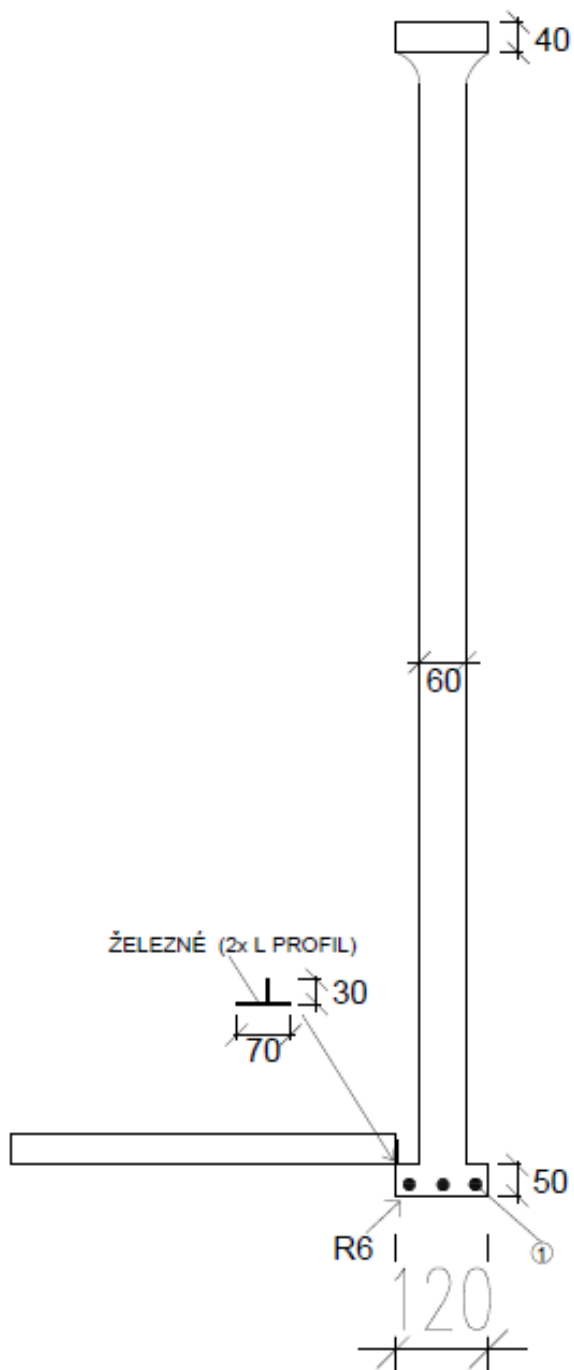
SS4 – popis střešní konstrukceFoto 059 – SS4 – popis střešní konstrukceFoto 060 – SS4 – popis střešní konstrukce
